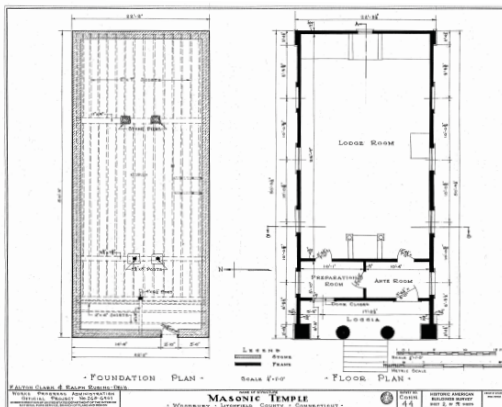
et 60 : Temple maçonnique de Woodbury, Connecticut. Architecte inconnu, 1838. Plans et coupes.
